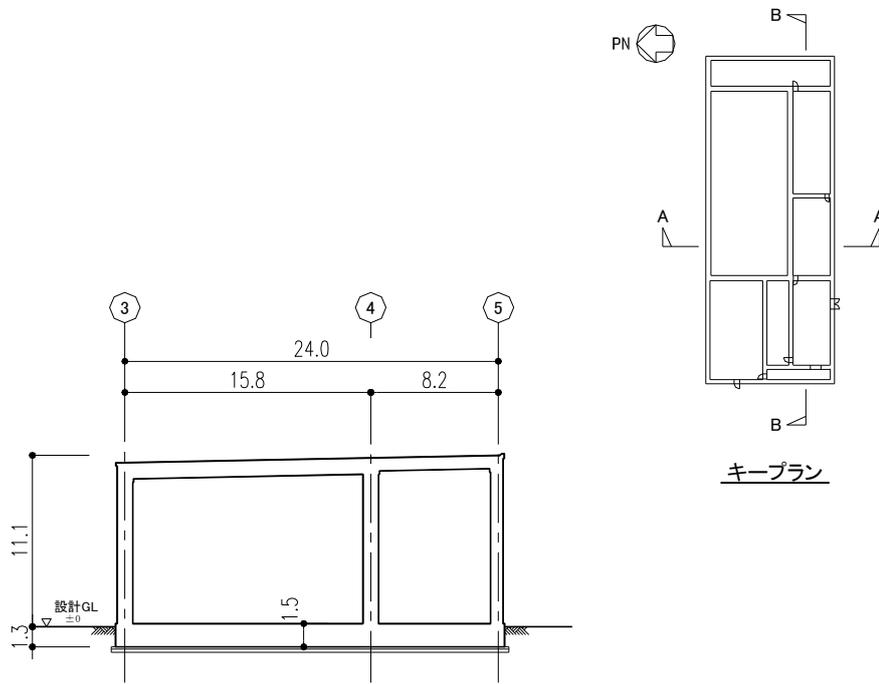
スラッジ棟 A-A断面図 (NS 方向) (単位 : m)
